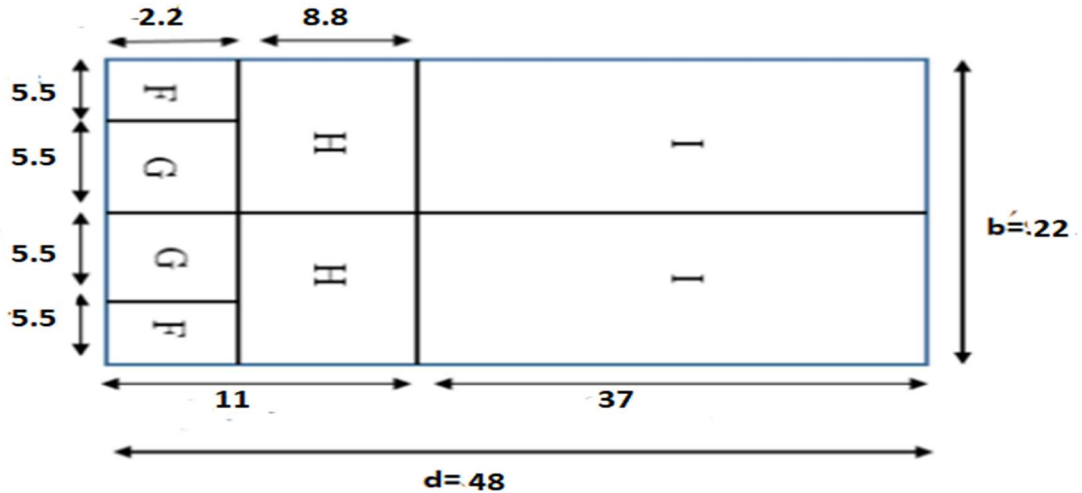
vue en plan des zones de pression sur la toiture suivant V1
